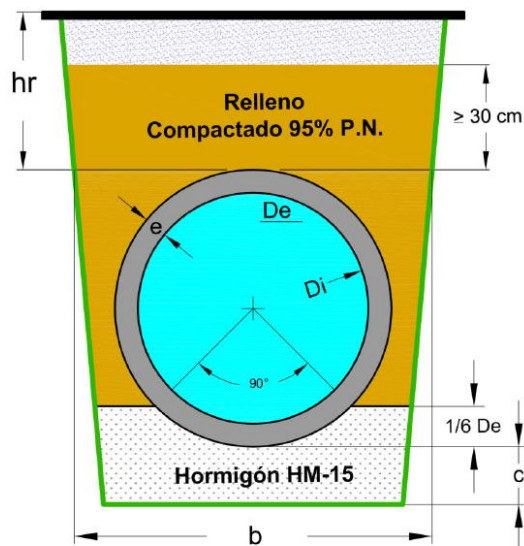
Sección constructiva colector HA. Fuente: Elaboración propia.
